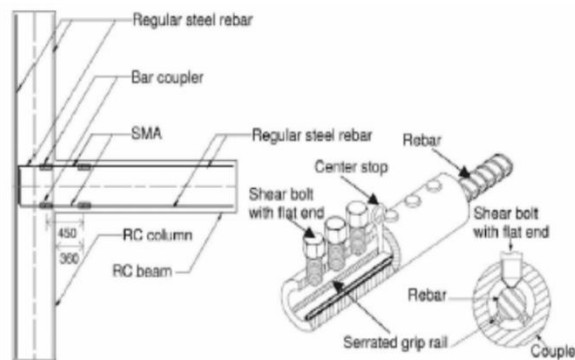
Détails de l'armature de l'élément poutre-colonne avec coupleur (dimensions en mm) (Alam et al., 2008).
